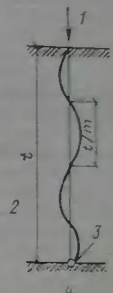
Схема продольного изгиба сваи в слабых грунтах большой мощности
